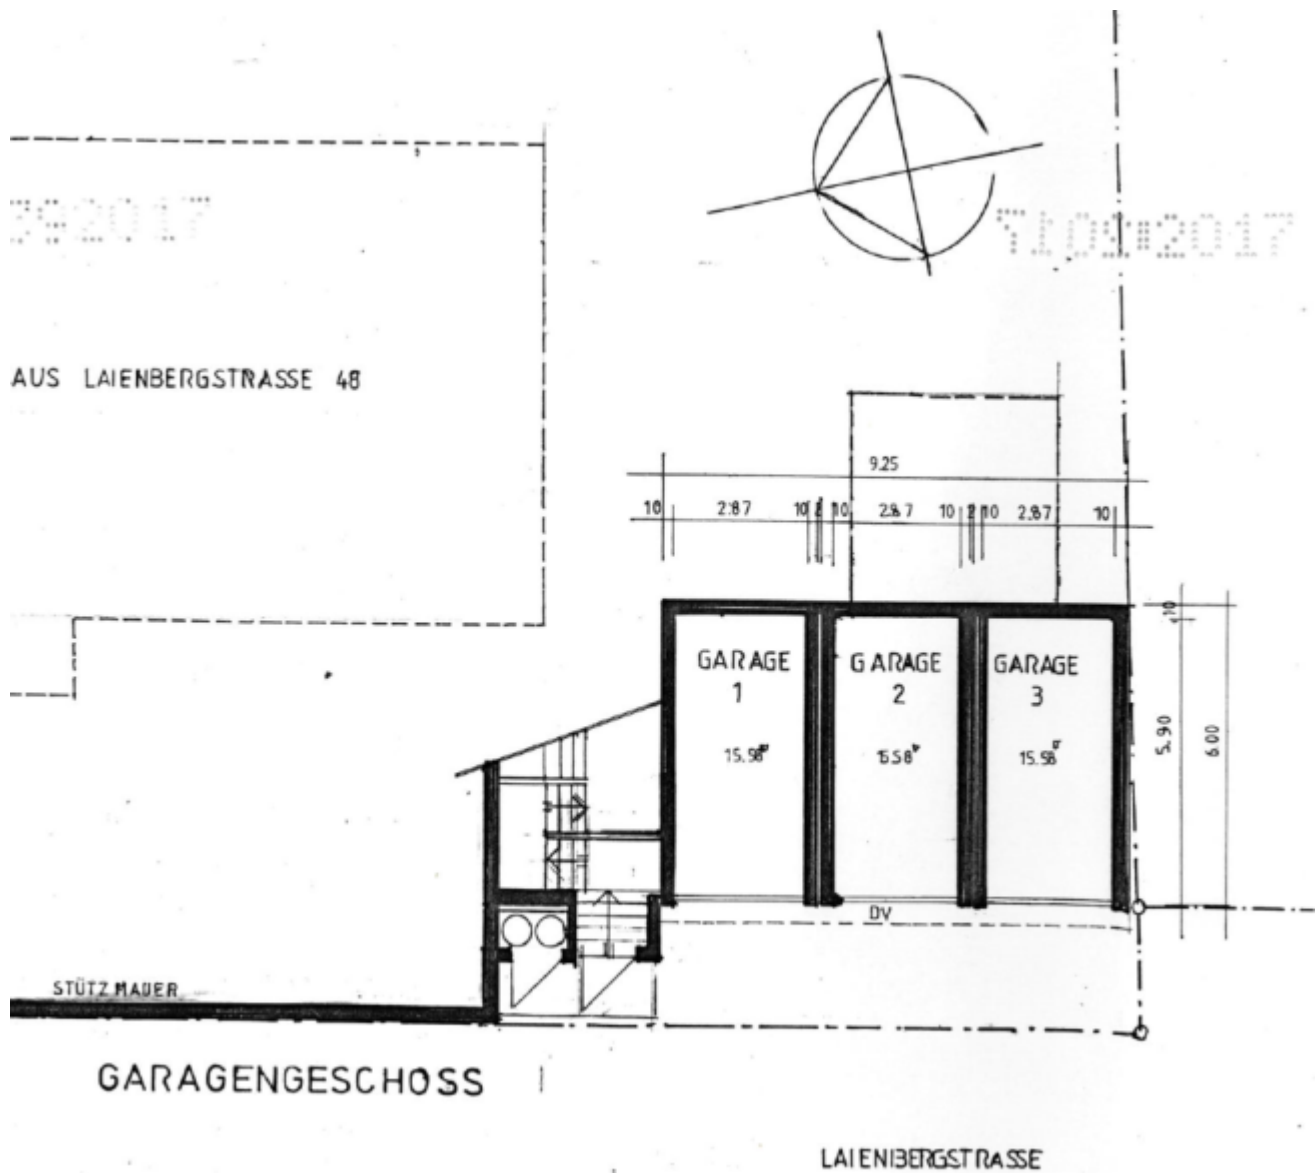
Grundriss Garagen; Quelle: Bauakte; Dachgeschossausbau Nachgesuch; 2017
